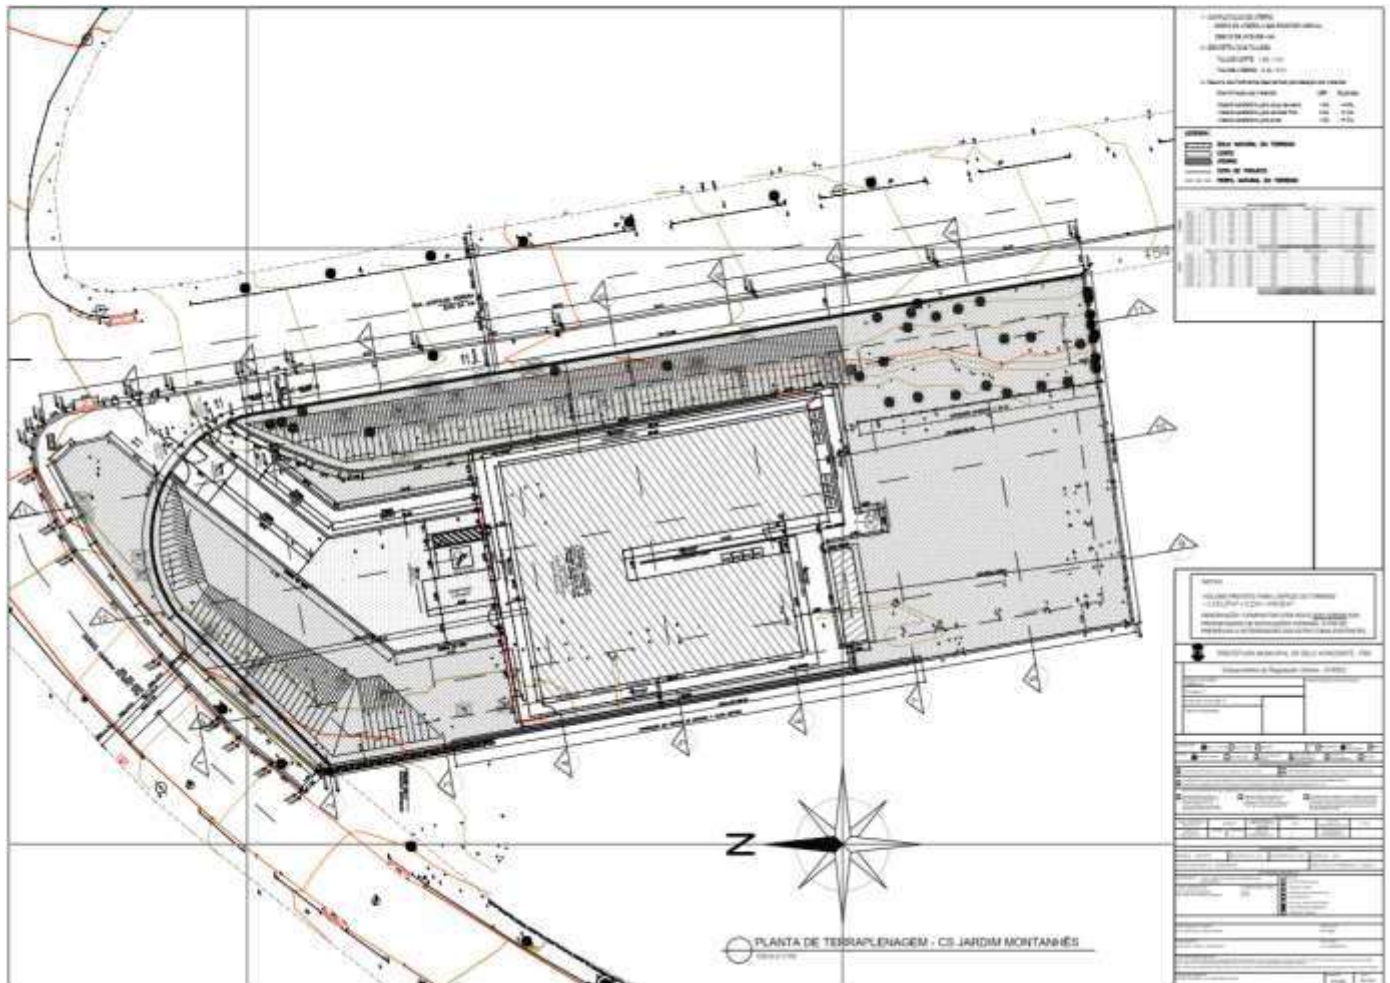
Planta do Projeto de Terraplenagem. Fonte: Odebrecht, Jun/2026.
